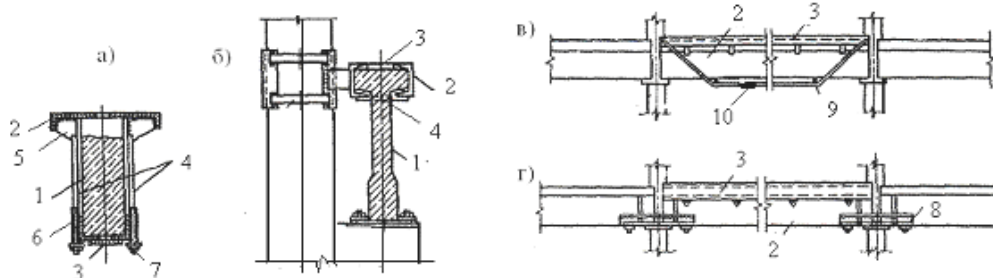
Варианты усиления железобетонных подкрановых балок:
